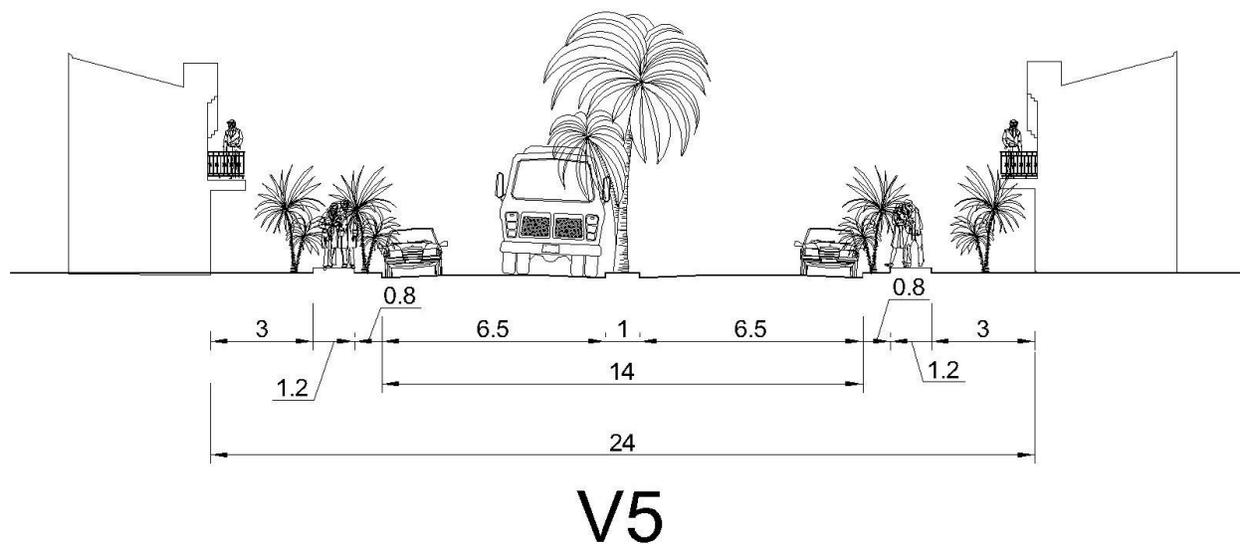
Perfil vial tipo V5. Correspondiente a una vía arterial. Fuente: P.O.T. plano U 13
